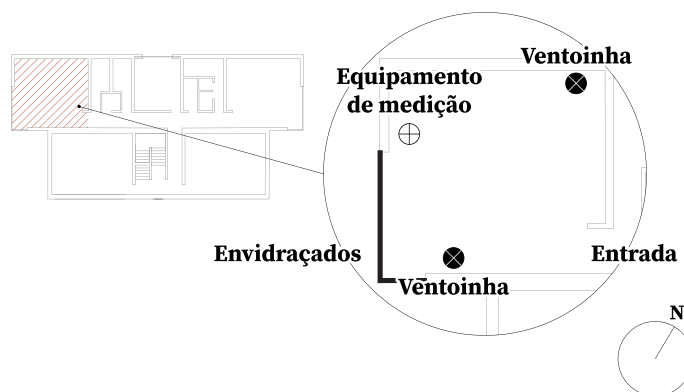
Localização em planta da Sala União (Piso 1) e do aparelho de medição (Adaptado do projeto fornecido pela Câmara Municipal de Matosinhos).
